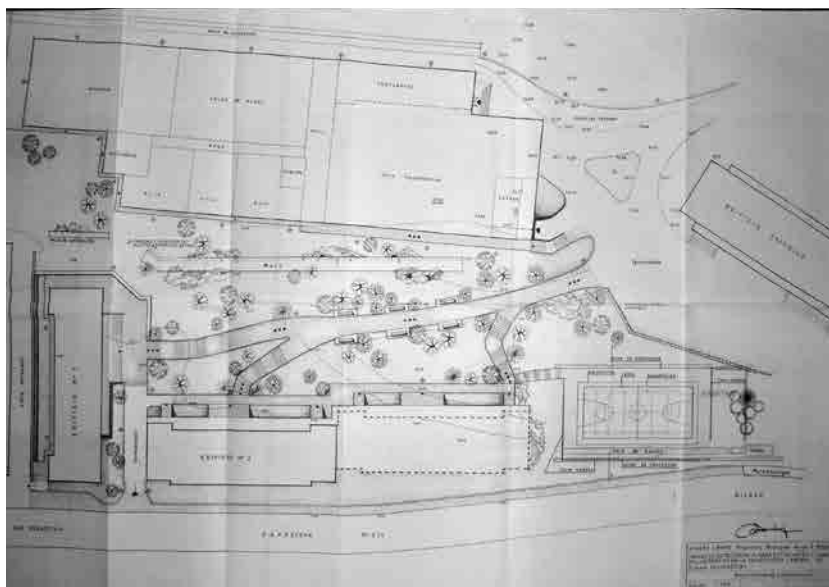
Plano de ordenación de la ampliación del conjunto.
